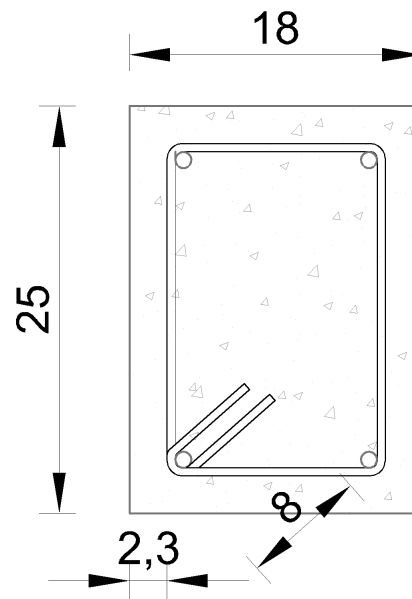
Detalle de las barras de refuerzo: recubrimiento, ganchos de estribos (Hausler, 2008).
